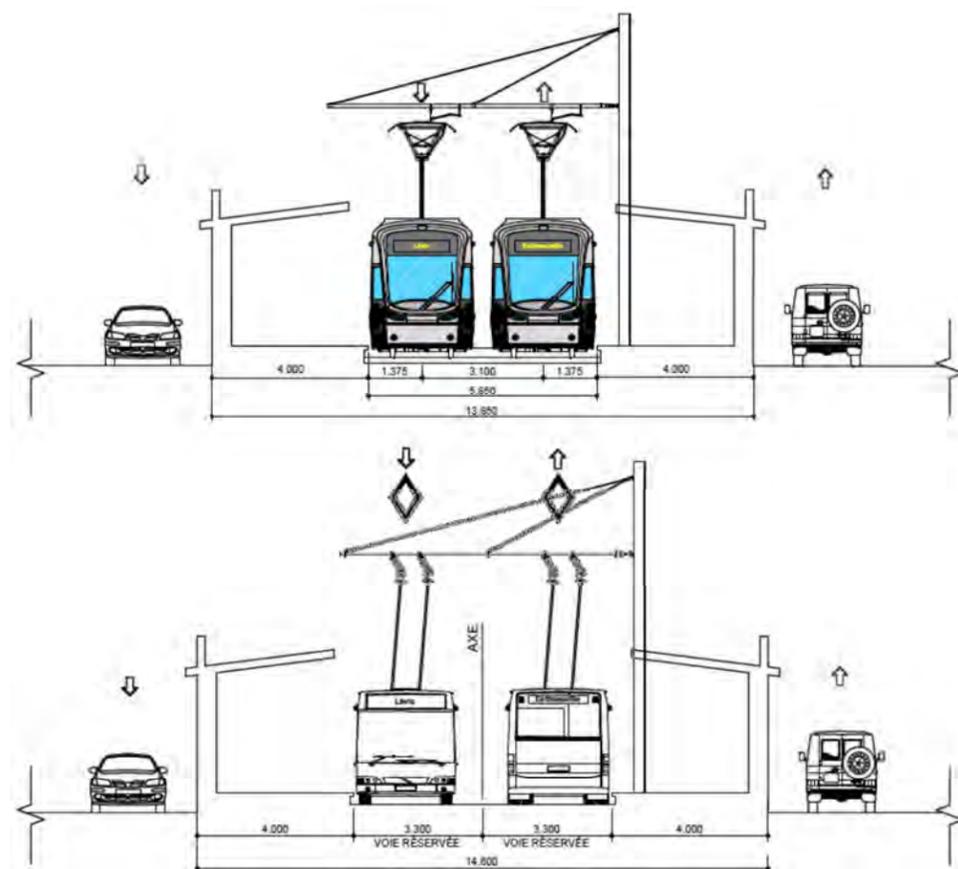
Coupe type 14 de 15 - SRB - Site propre standard en station - Quais latéraux
